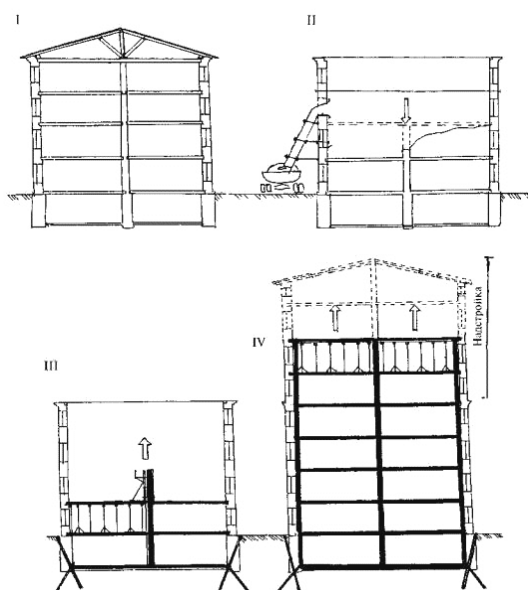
Технологическая последовательность реконструкции зданий методом встроенных строительных систем с надстройкой этажей
